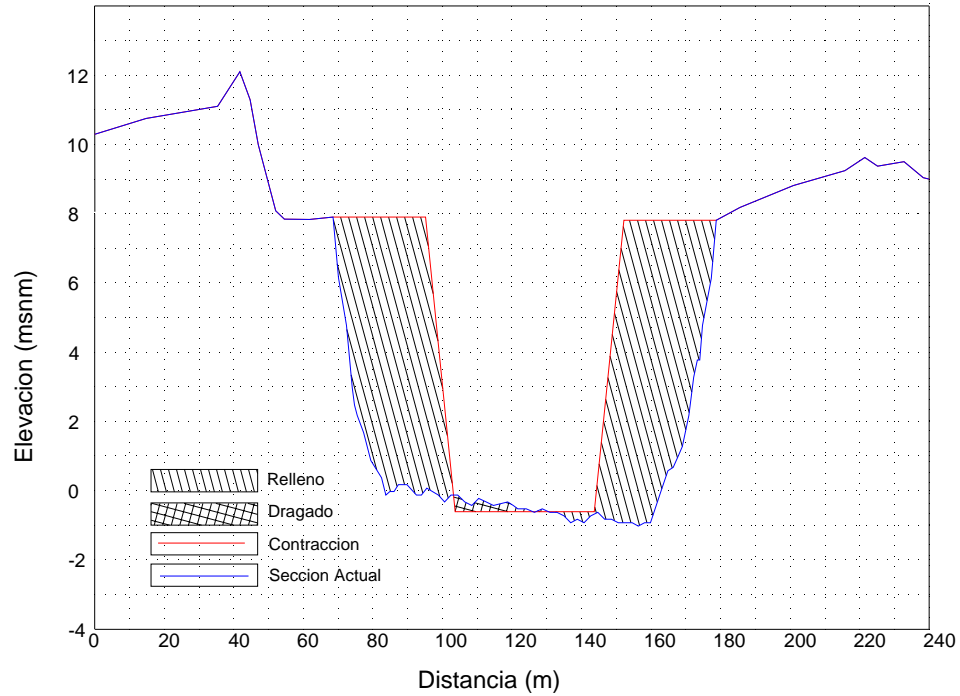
Sección transversal km 3 - Contracción No. 1
